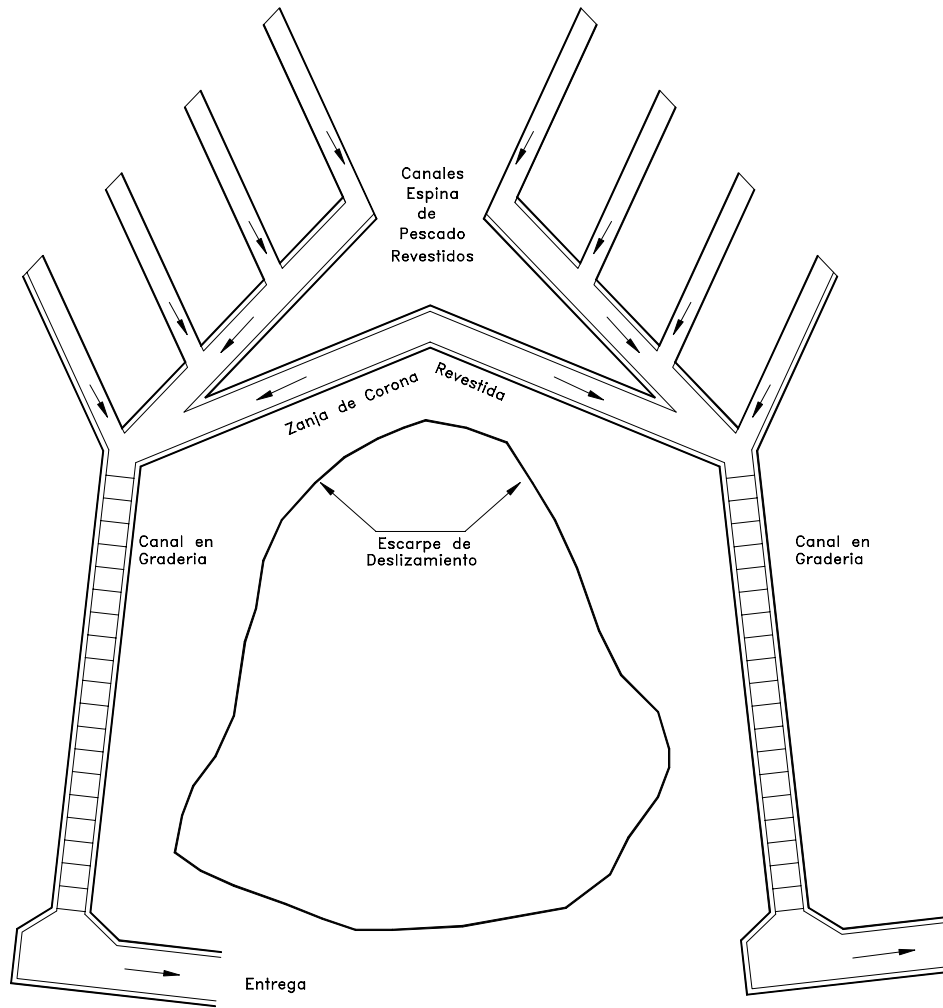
Esquema en planta de canales colectores espina de pescado
